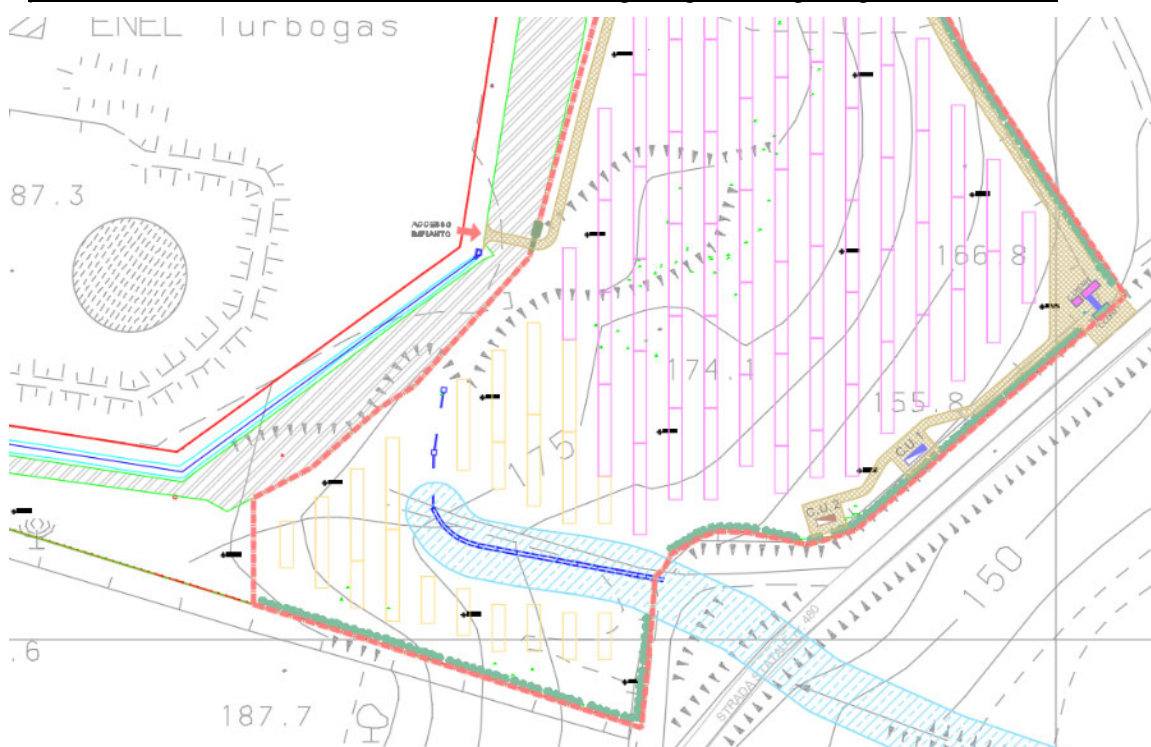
stralcio planimetria di layout di impianto con particolare reticolo e fascia di rispetto (linea blu e retino ciano) non interferenti con le strutture fv
